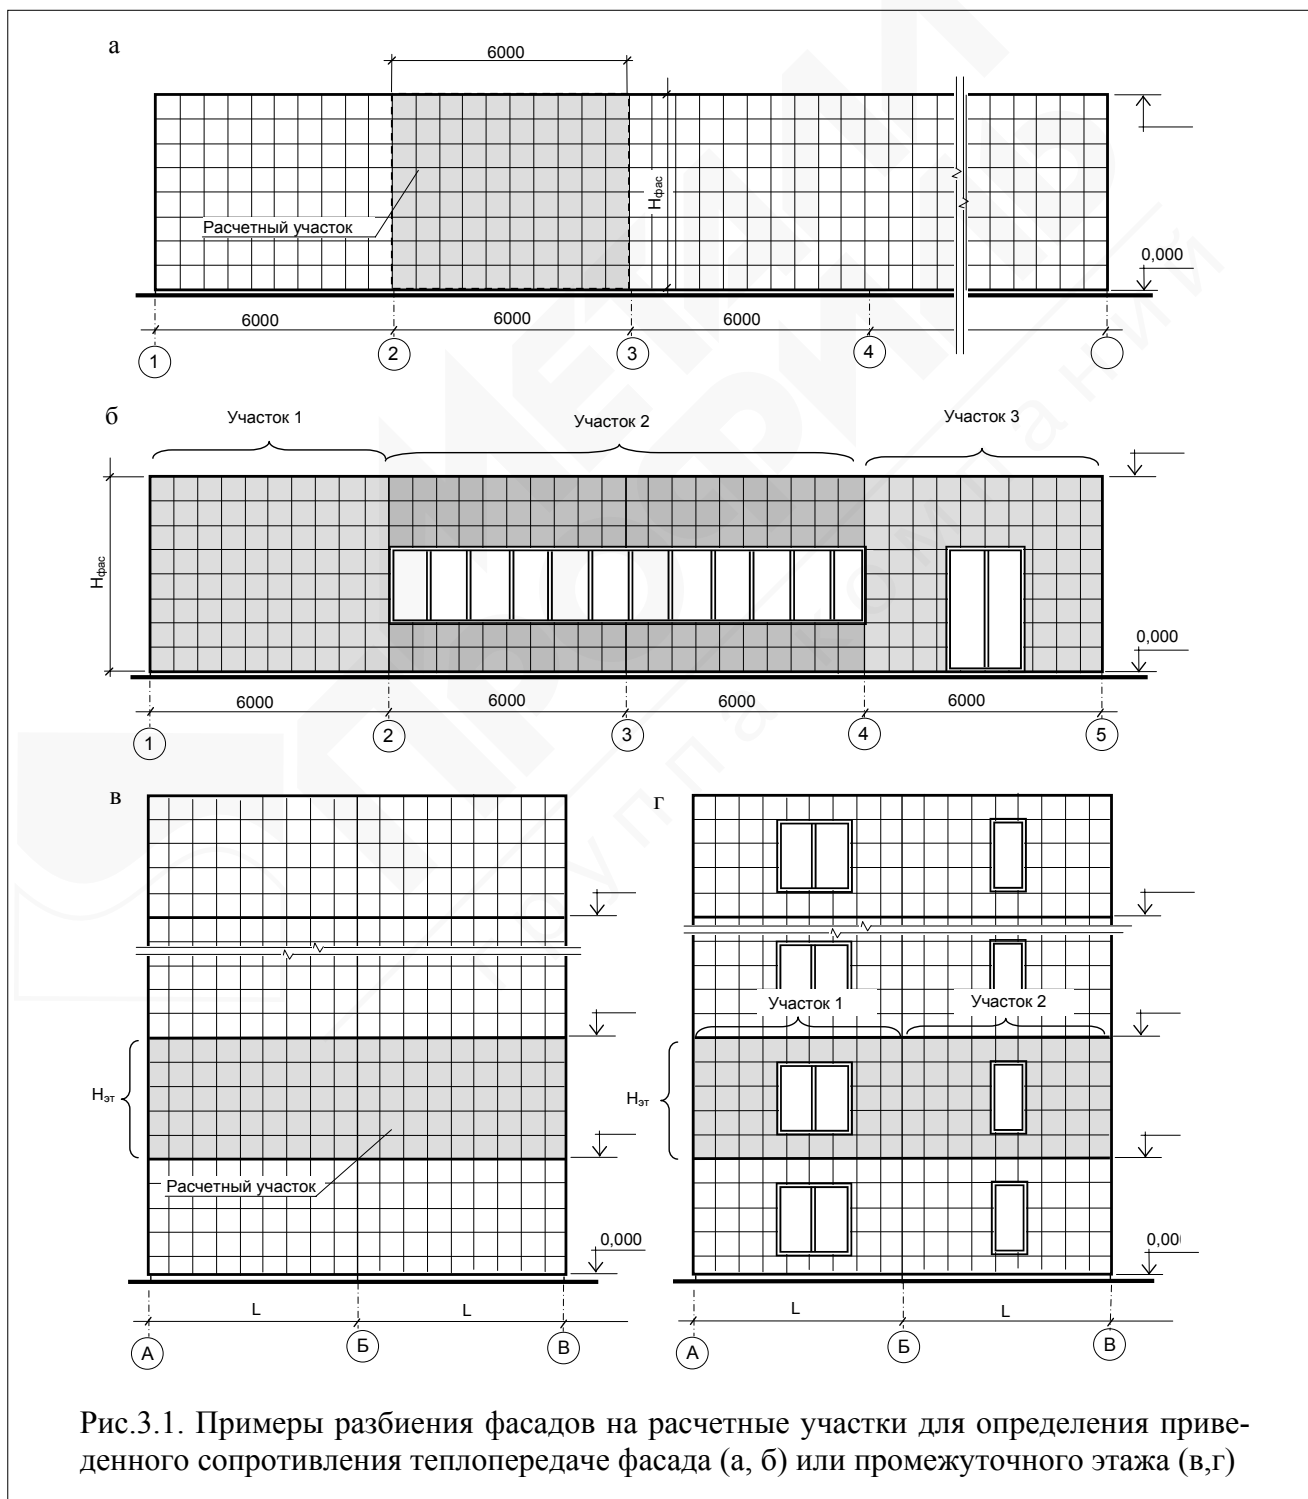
Примеры разбиения фасадов на расчетные участки для определения приведенного сопротивления теплопередаче фасада (а, б) или промежуточного этажа (в,г)
